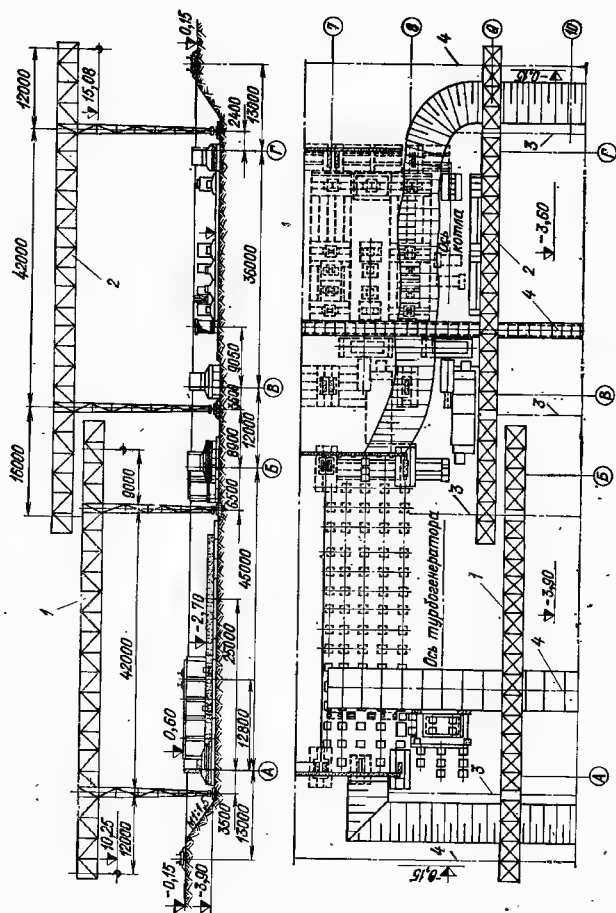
Монтаж козловым краном строительных конструкций подземного хозяйства:
